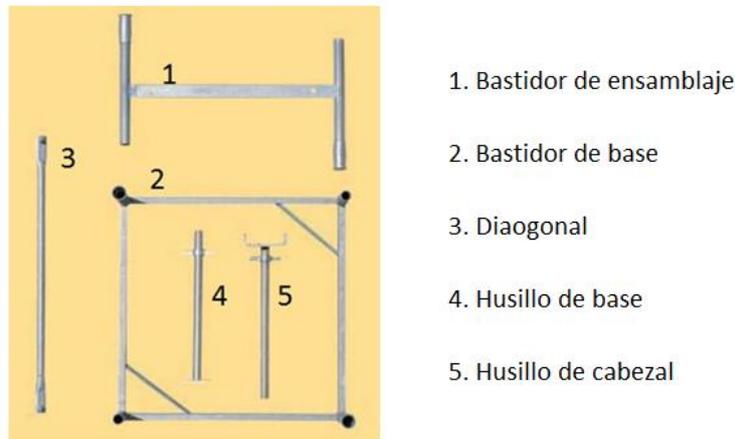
Detalle de las 5 piezas básicas de montaje Peri ST100.
